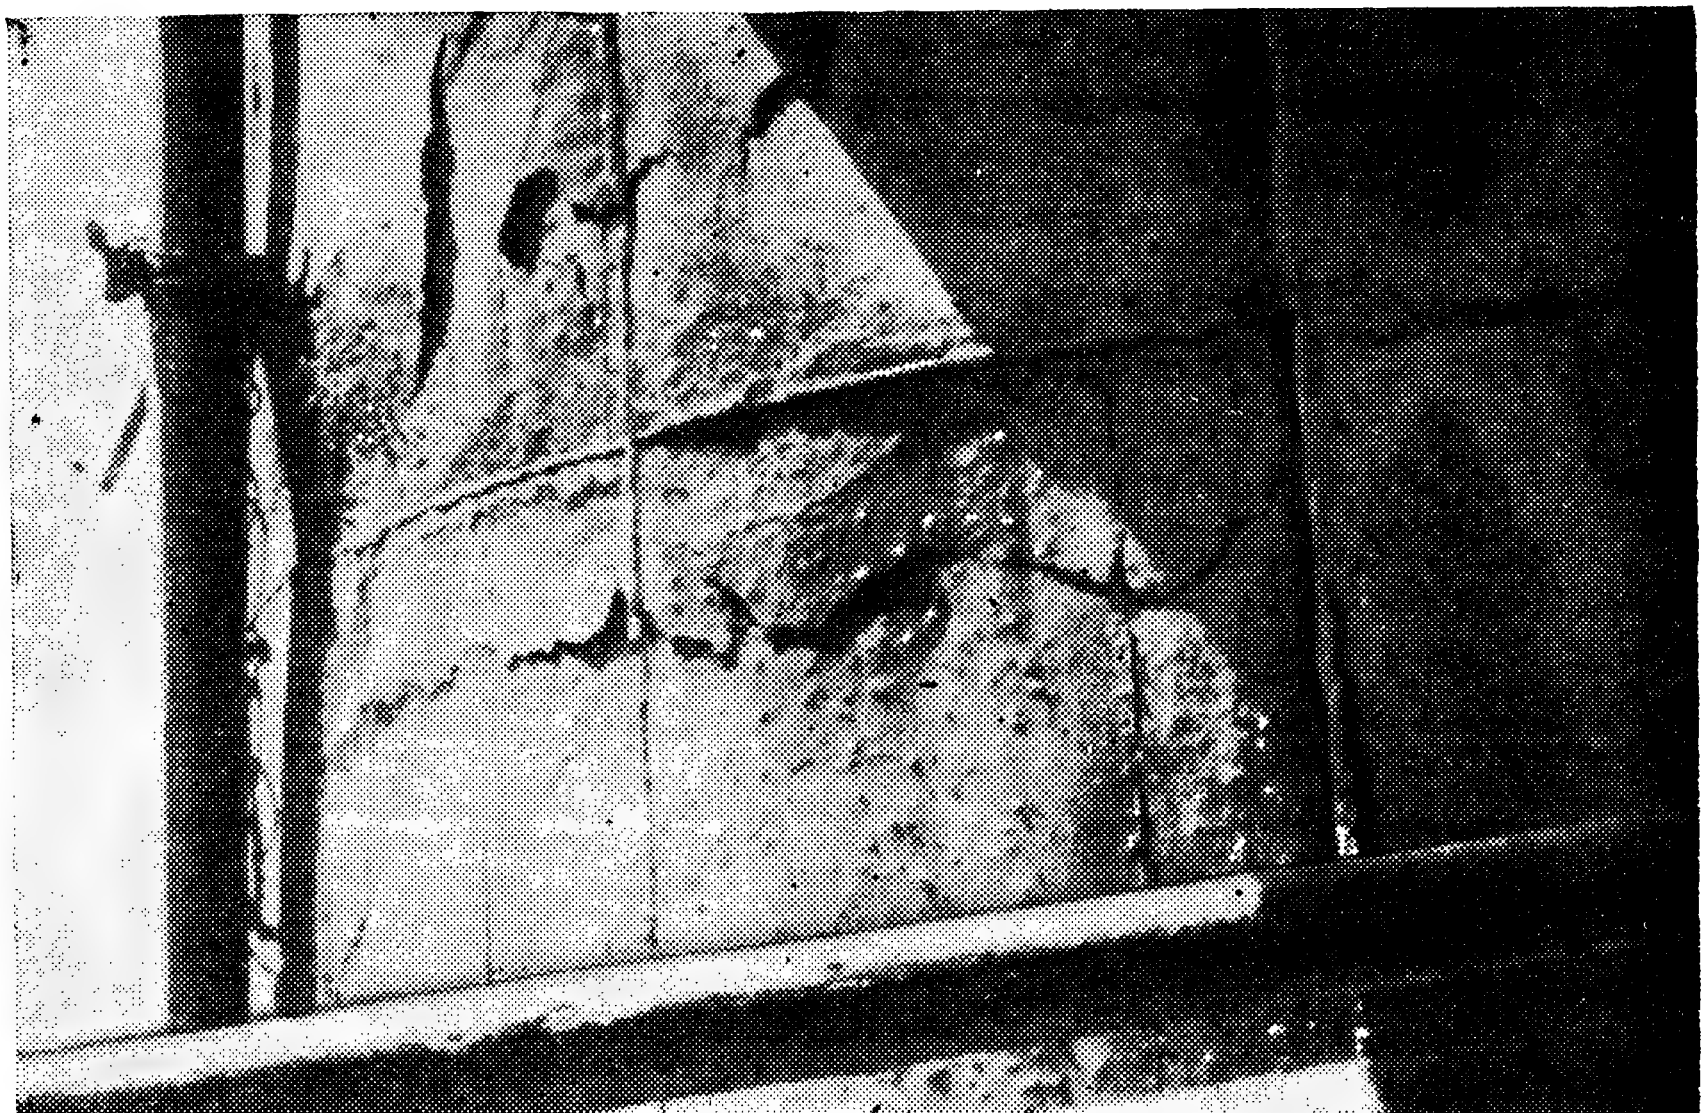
Коррозия арматуры становится заметной лишь при отслоении бетонного покрытия
